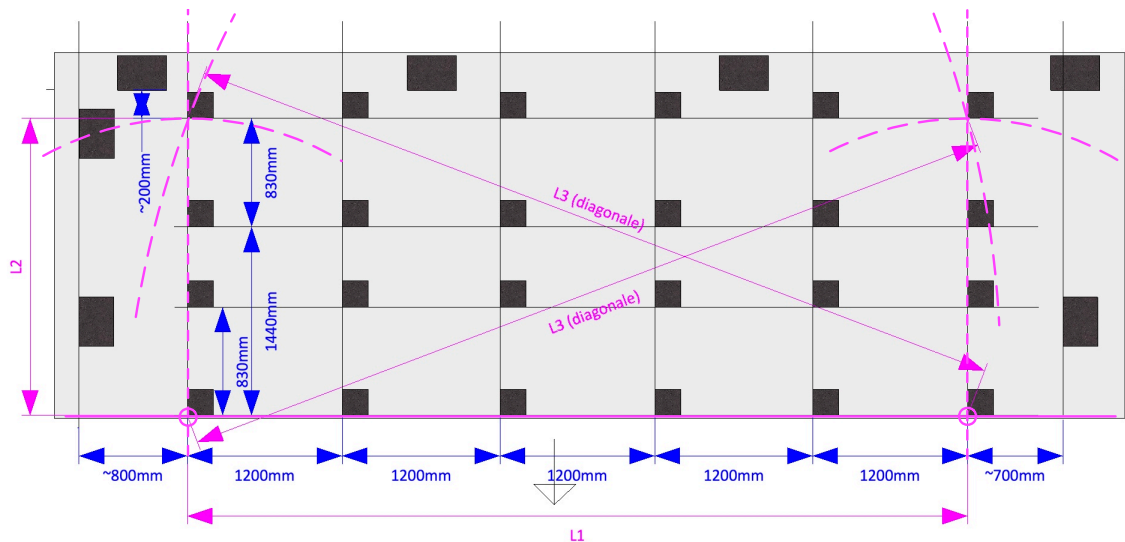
Montage mit 15° - Montagemasse der Schutzmaten
